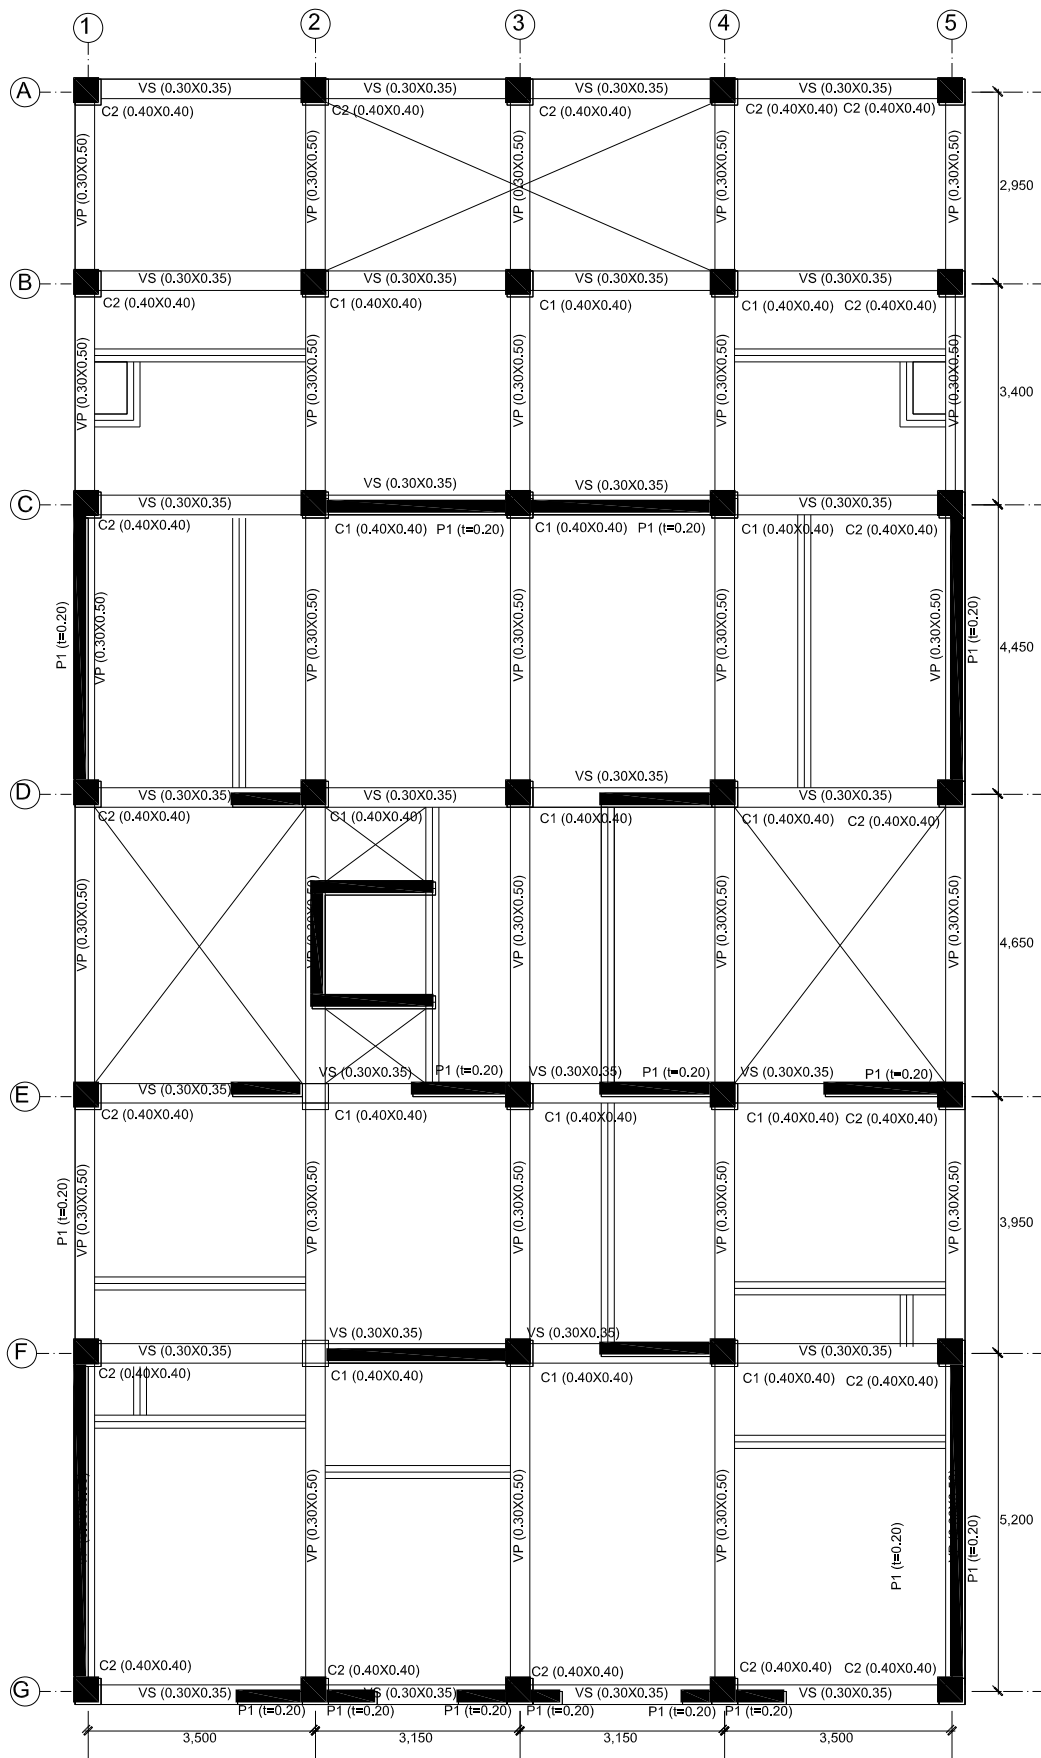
Ubicación de los ejes y distribución de los elementos estructurales.
